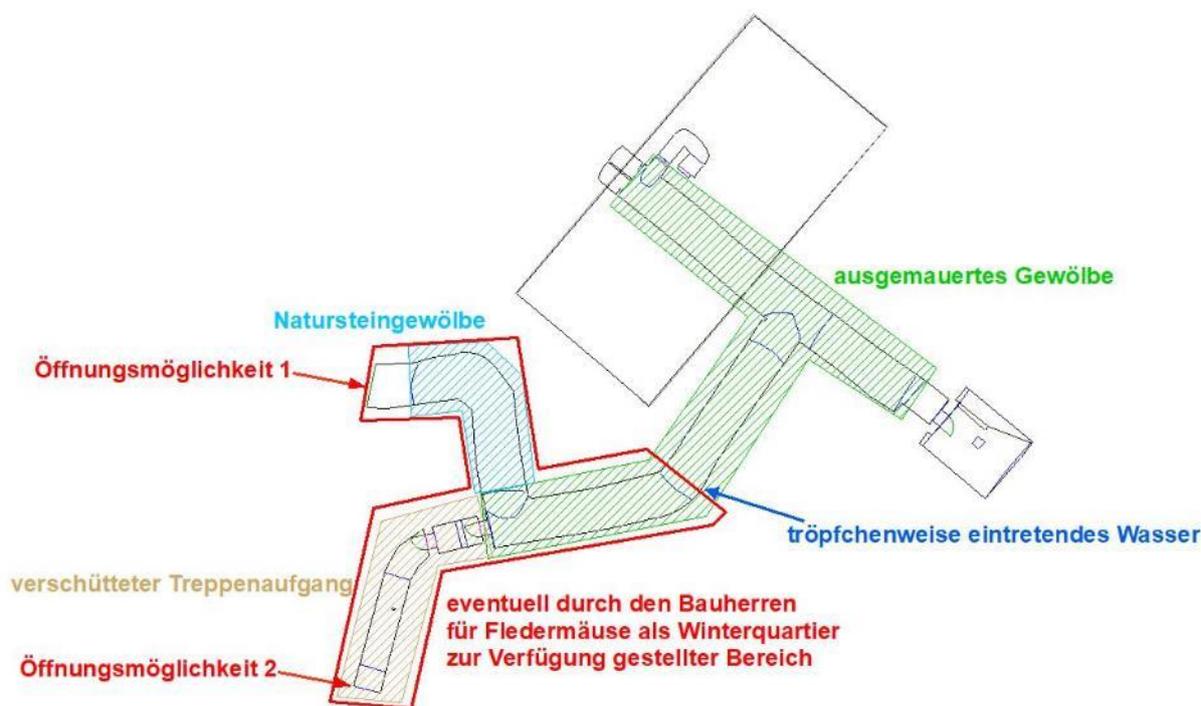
Grundriss des Tiefkellers mit Darstellung der für Fledermäuse relevanten Strukturen
